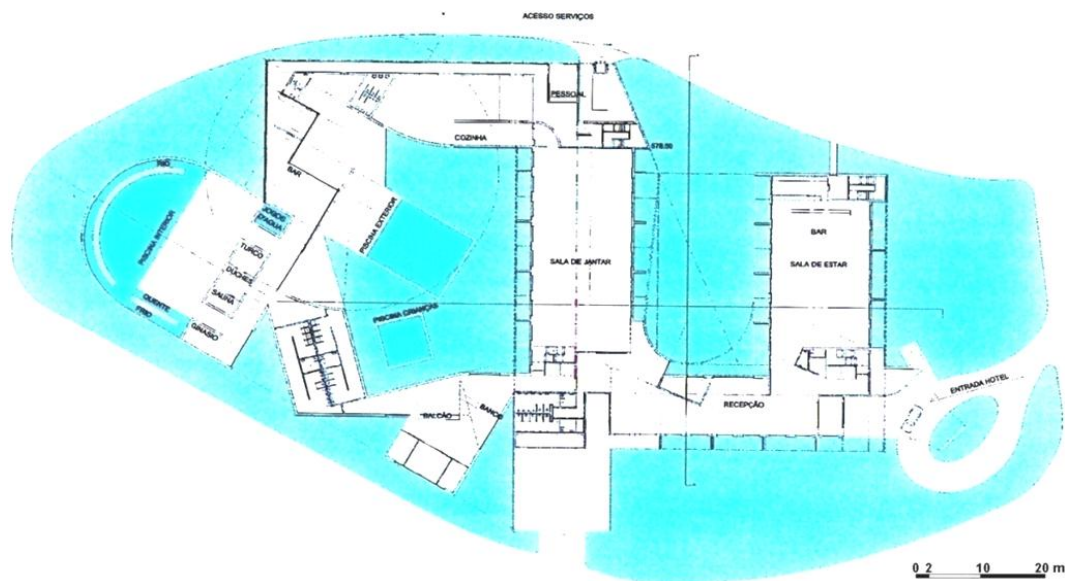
Proposta do novo Hotel Avelames, planta do piso 0.
